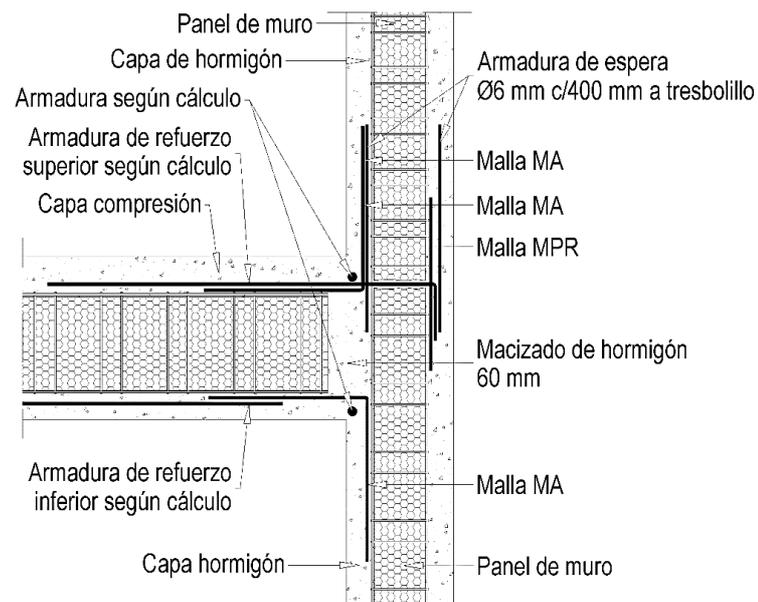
Detalle de unión entre muros y cubierta plana (en sección).
